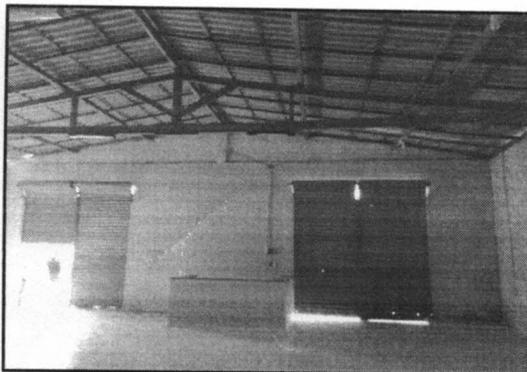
Vista da Galpão, com destaque a cobertura com estrutura com trama de madeira e telha de fibrocimento.
